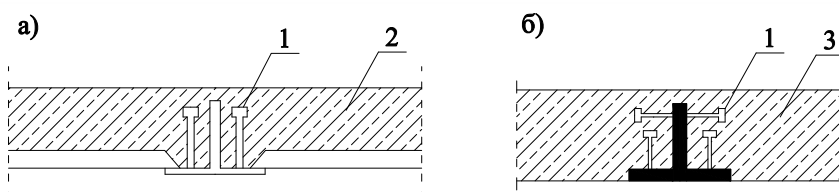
Сечения жесткой арматуры, используемой в сталежелезобетонных перекрытиях [13]
